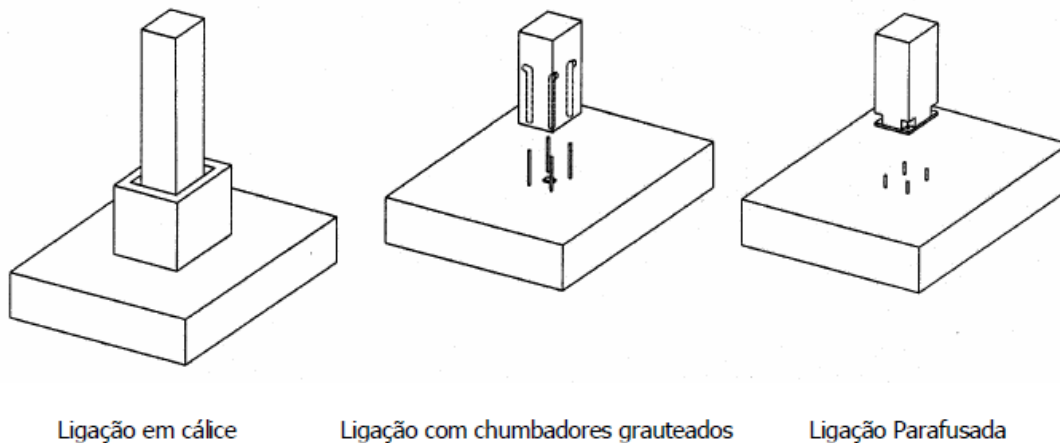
Pormenor das fundações pré-fabricadas [33]
